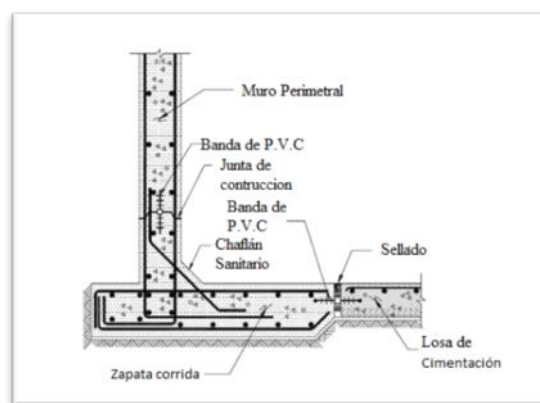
Esquema de detalle estructural de tanque en concreto reforzado. Tomado del Manual de diseño y construcción de estructuras de concreto para almacenamiento de agua de Victor M. Pavón Rodríguez
